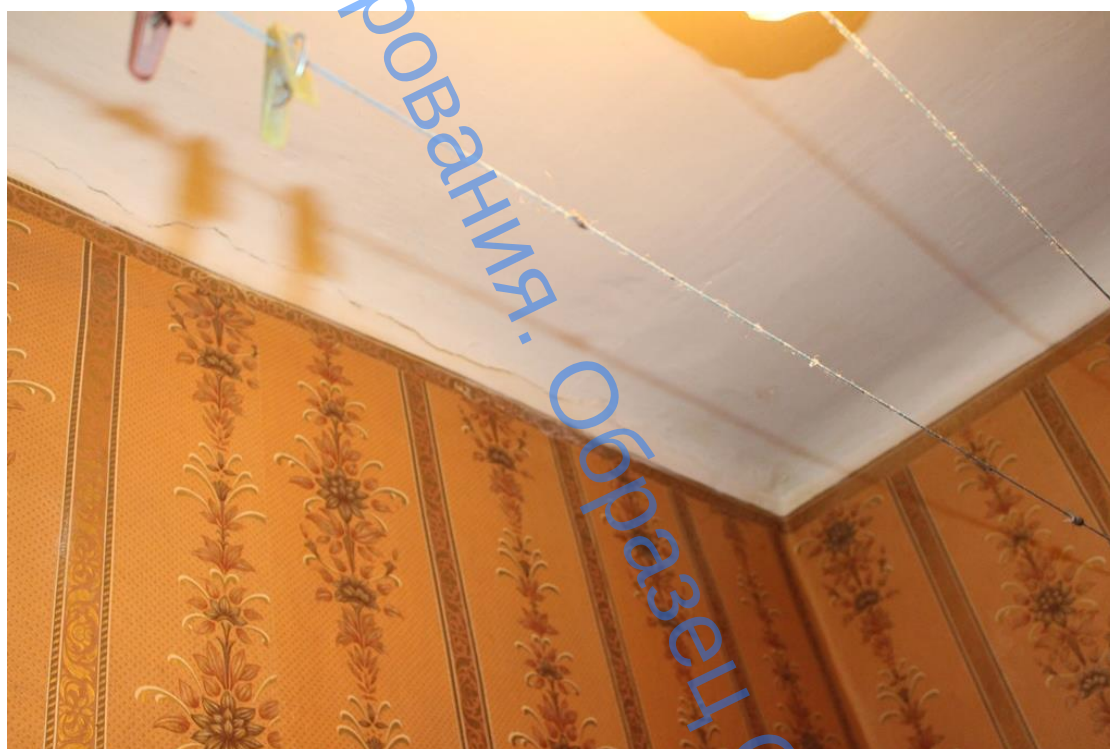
Перекрытие квартира 11 (трещина вдоль раскладки балок), створ трещины между осей 1 и 2.
